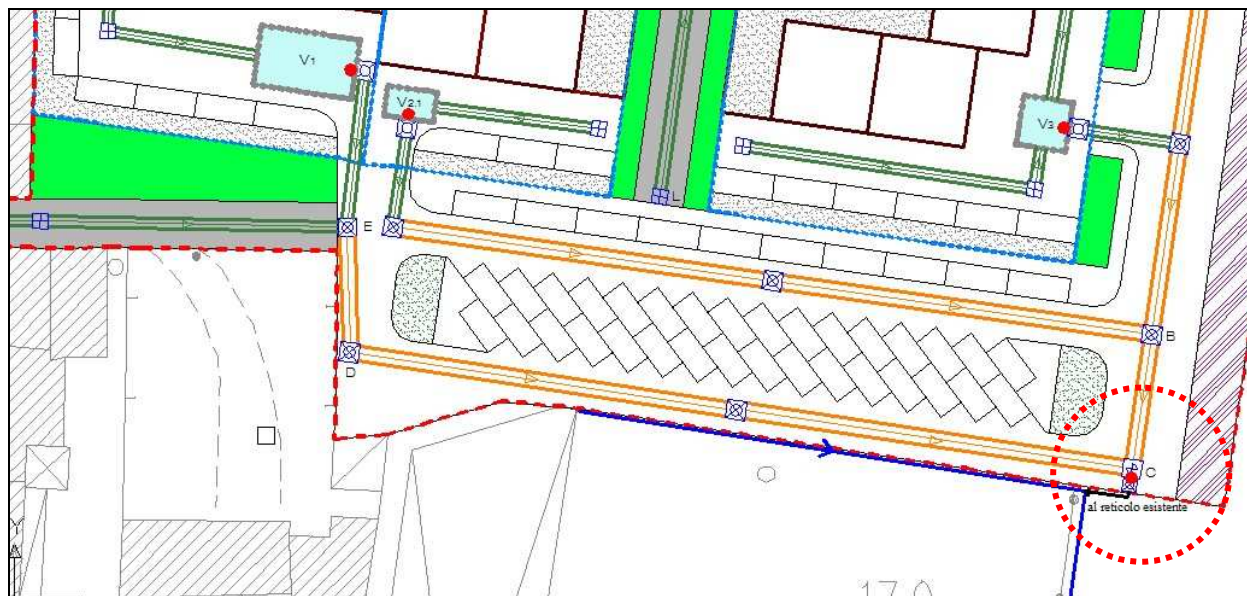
particolare della planimetria generale della fognatura delle acque meteoriche a servizio della parte pubblica necessaria per il mantenimento dell'invarianza idraulica con individuazione del pozzetto di scarico
